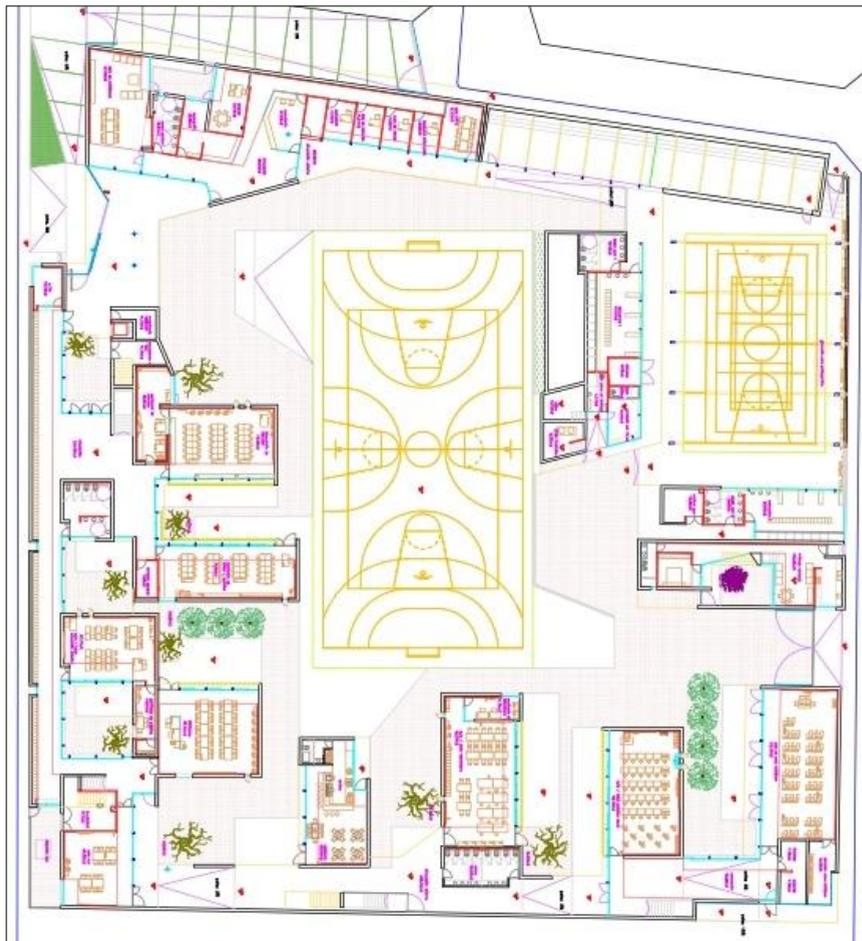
Planta baja P. Modificado. Enero 2009. Fuente proyecto de ejecución
